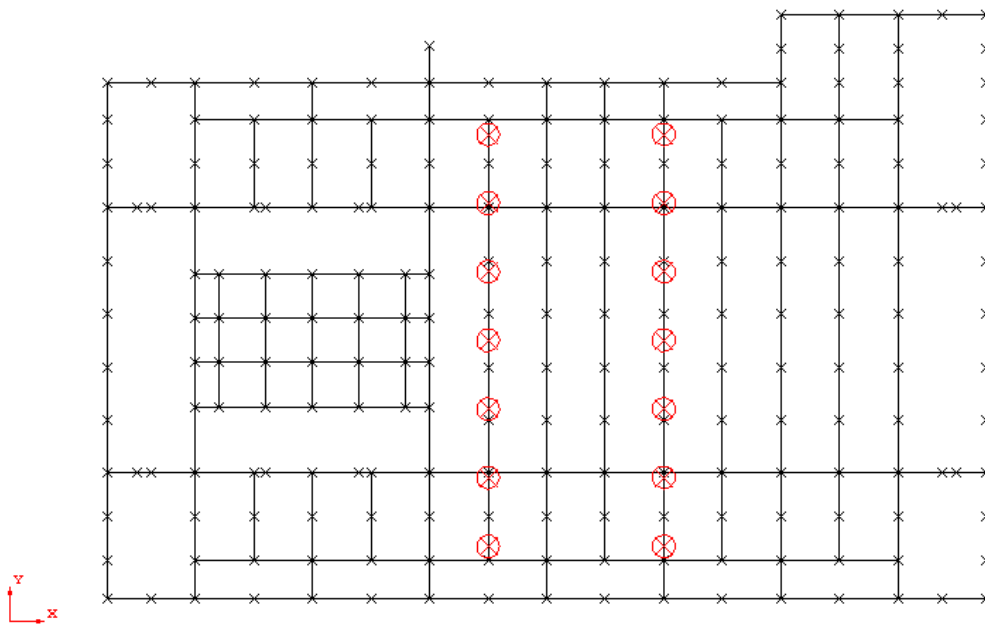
PAQUETE DE BOMBAS – APLICACIÓN DE CARGA CUBIERTA SUPERIOR.
